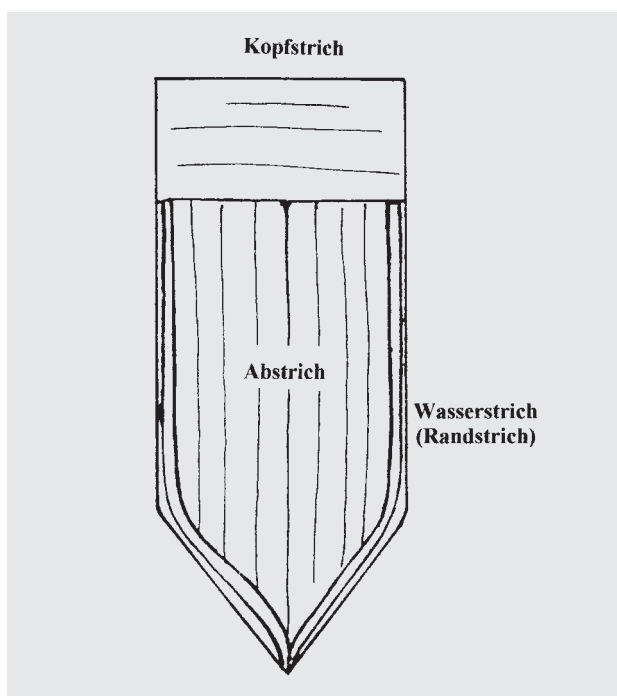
Ziegel mit Kopfstrich, Abstrich und Wasserstrich
